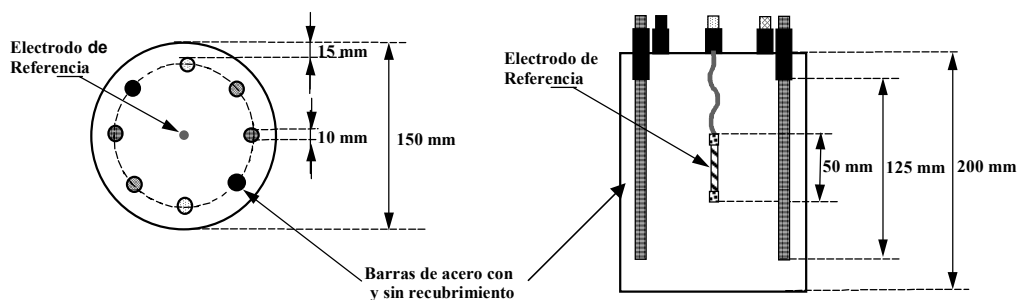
Esquema de las probetas de hormigón con barras de acero empleadas en el estudio.
